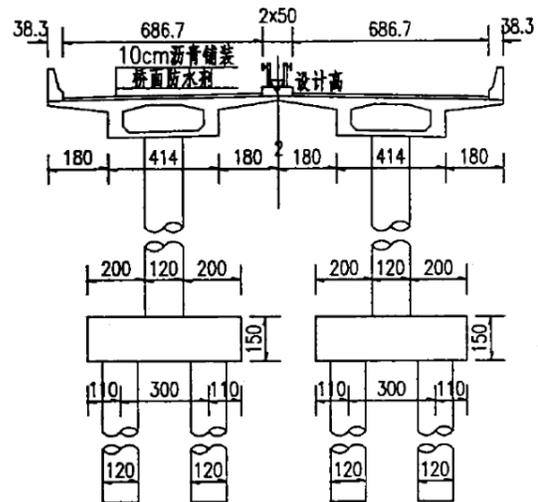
A 匝道桥剖面图 (桥墩处)
